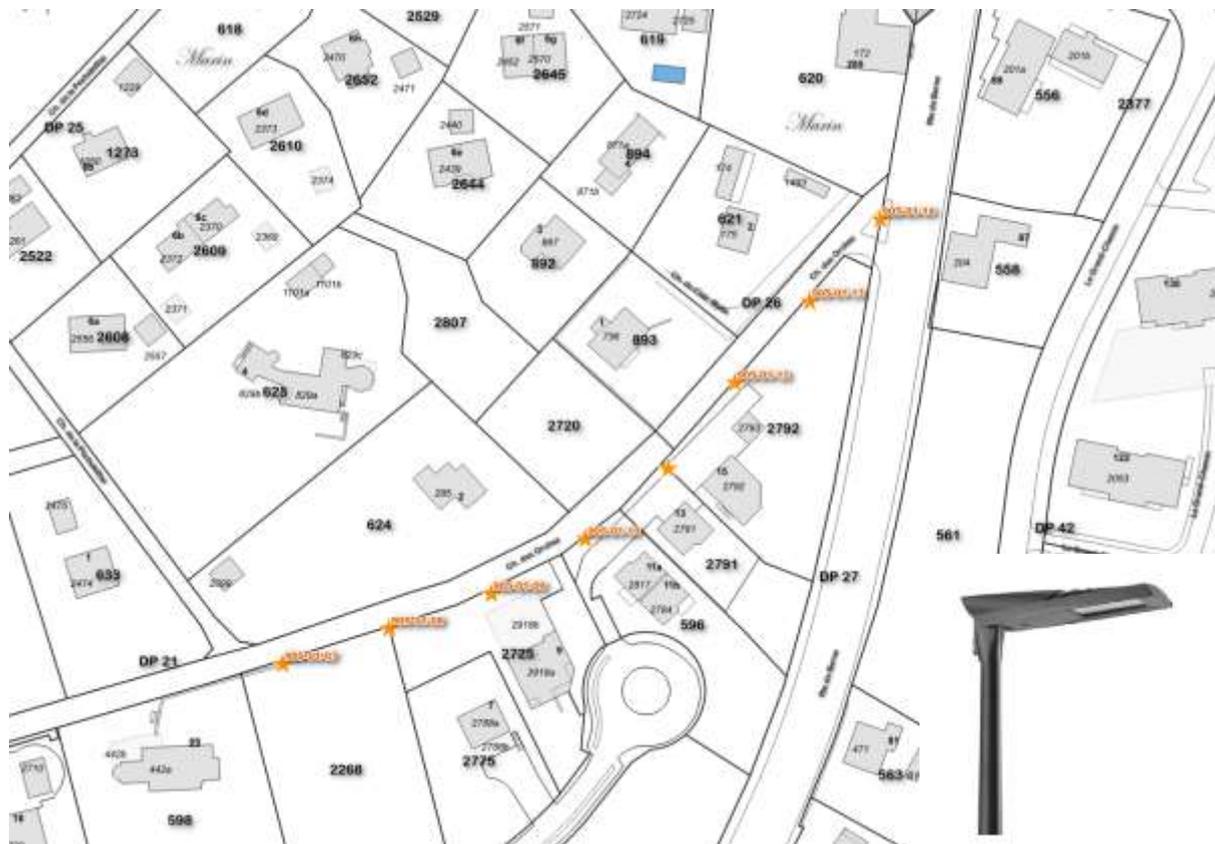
Plan de situation des luminaires existants sur le secteur concerné par les travaux et photographie d'un point lumineux
